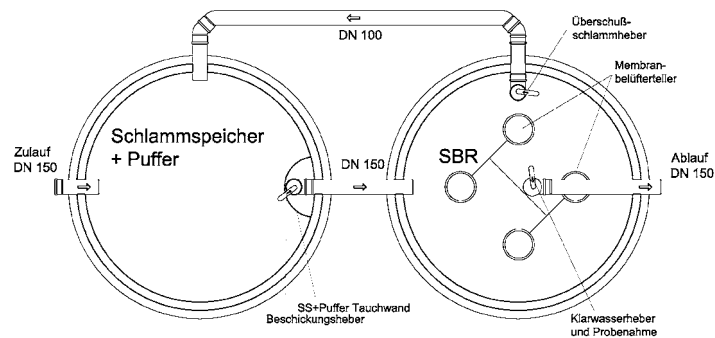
Schematischer Grundriss einer Zweibehälteranlage
